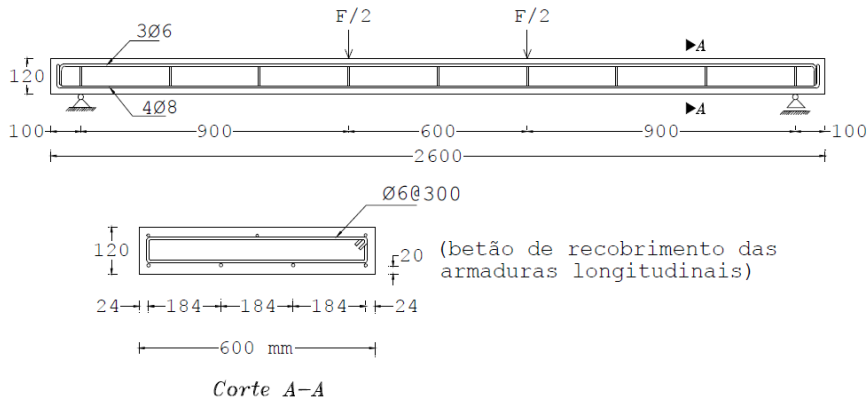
Informação geral sobre as lajes de betão armado ensaiadas por Hosseini *et al.* (2014) (dimensões em mm).
